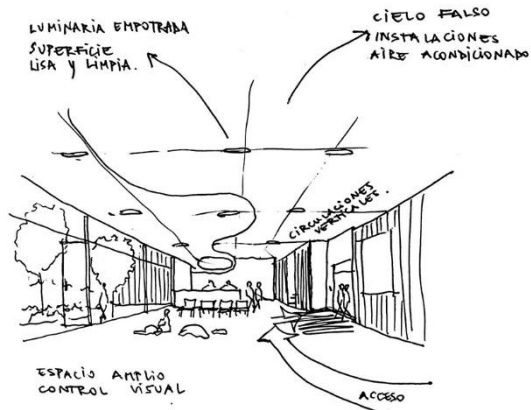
Croquis de detalle interior del proyecto. Fuente: Paula Fustos (2020).
